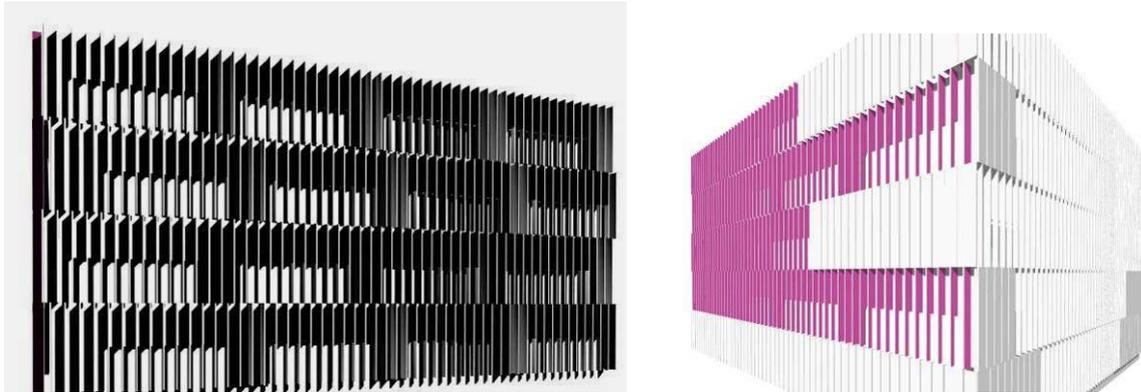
Licht- und Farbstudie zur Fassade mit vertikalen Lamellen.
